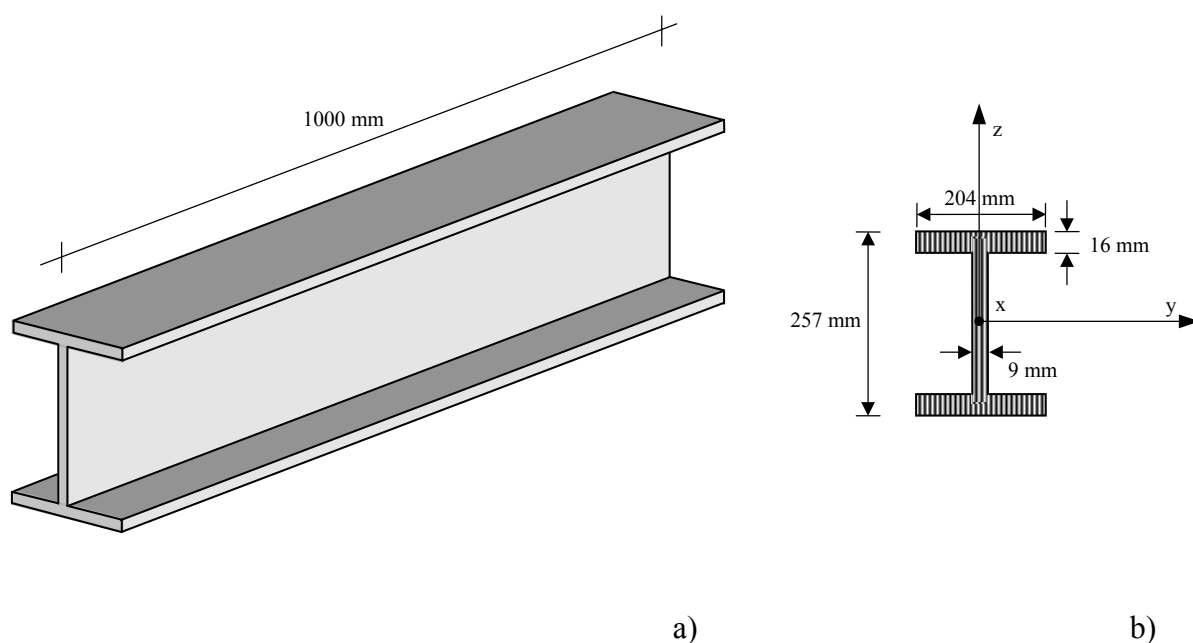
Viga I a) Geometria b) Seção transversal
